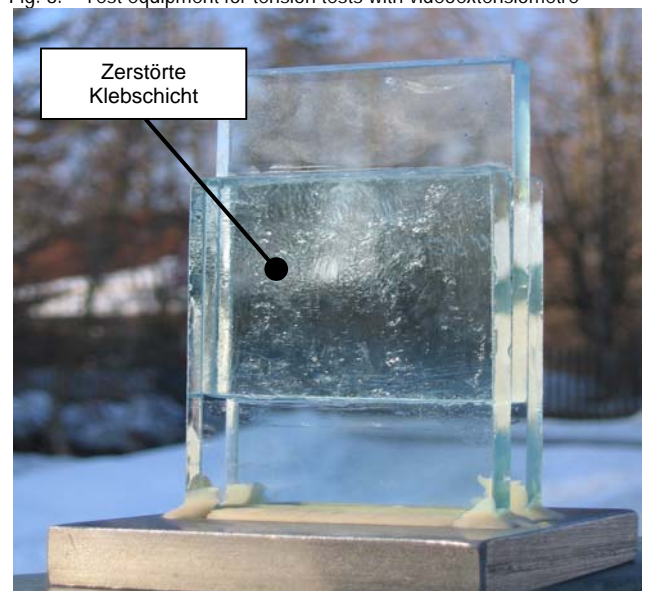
Schubprüfkörper für Duromere, nach dem Versuch (FHM)
